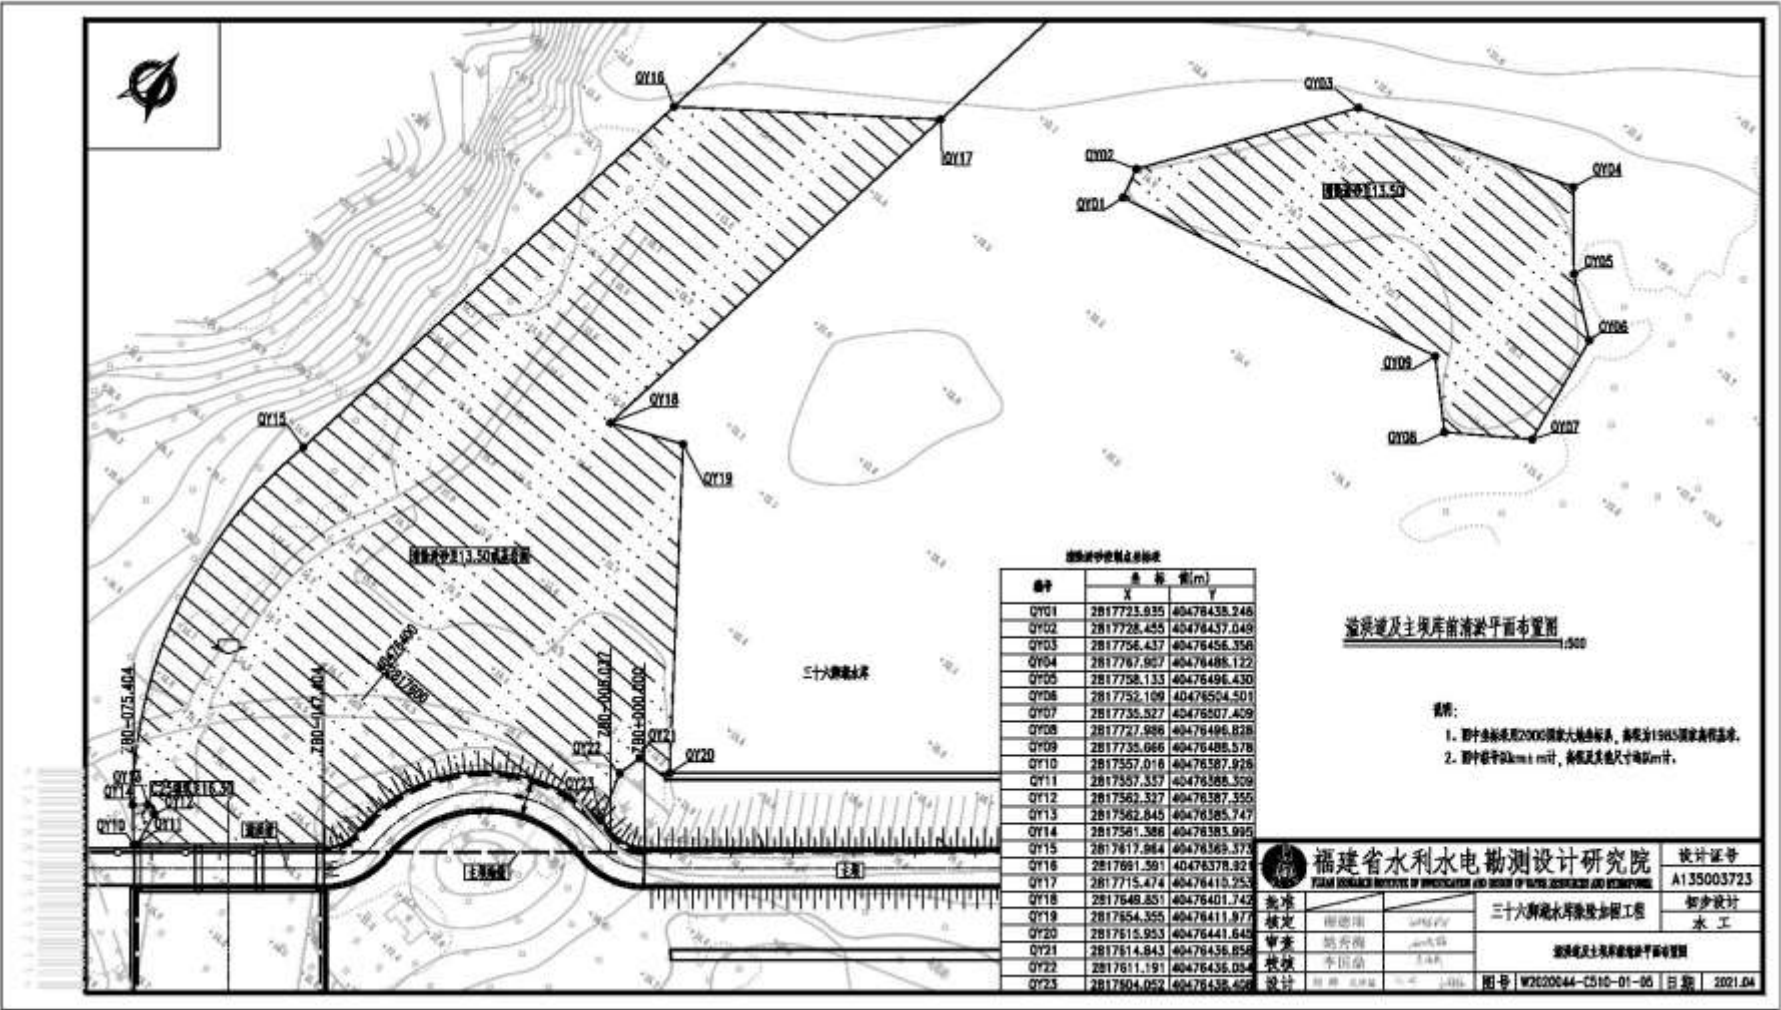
溢洪道及主坝库前清淤平面布置图
